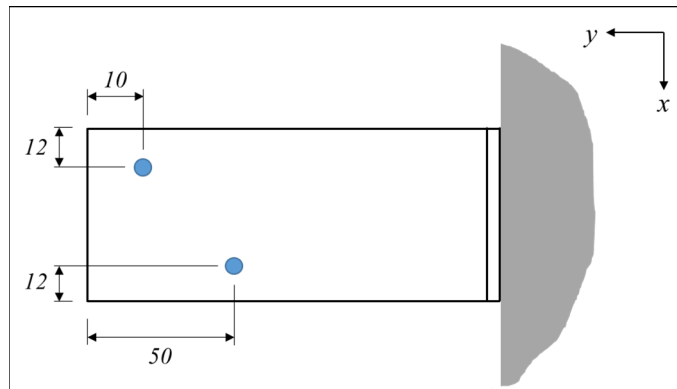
Disposition des fixations des montants horizontaux sur pattes-équerres en acier
